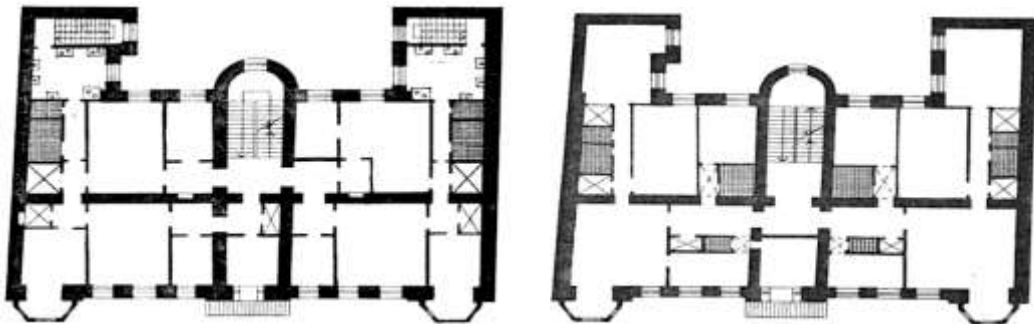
Плани поверху прибуткового будинку до і після перепланування
